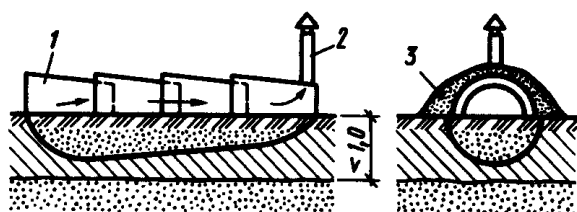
Оттаивание грунта огневом способом: 1 - камера сгорания; 2 - вытяжная труба; 3 - обсыпка талым грунтом
